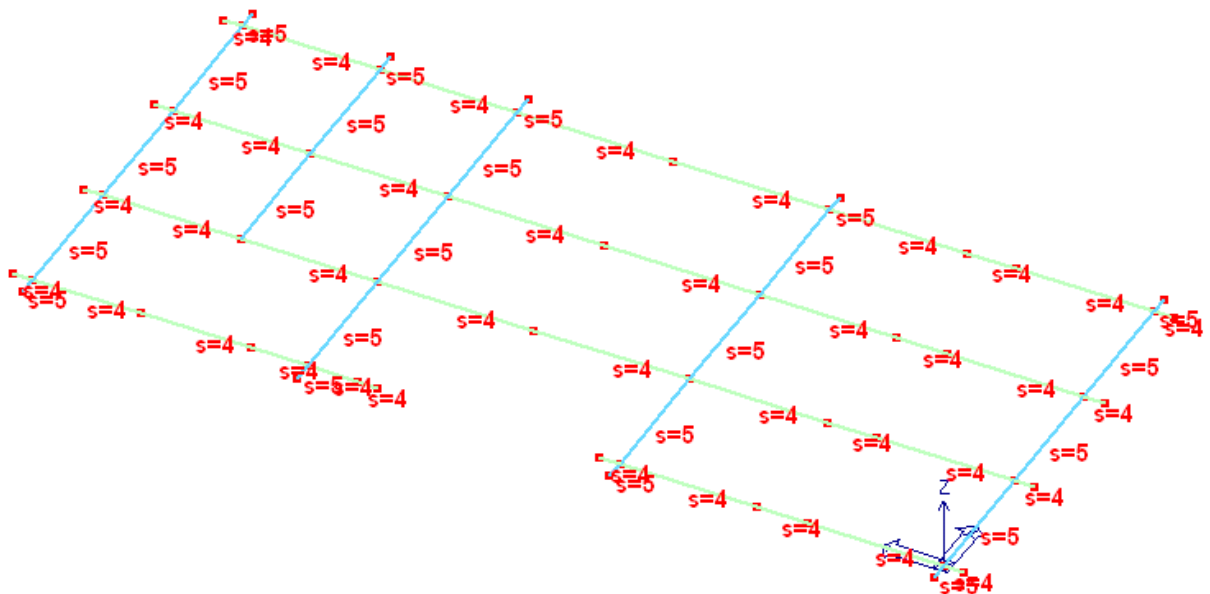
2 – Codice “Id”elementi strutturali in fondazione
